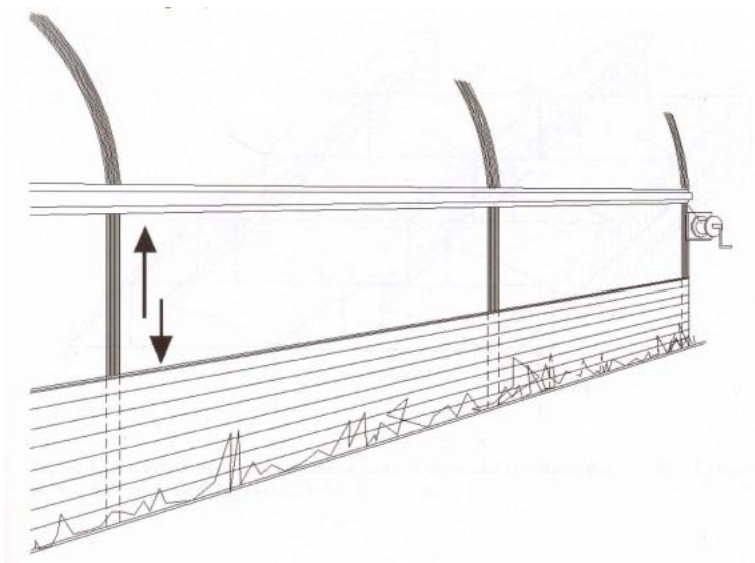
Voorbeeld van een hoge folietunnel met verticale zijgevels (Rovero).
